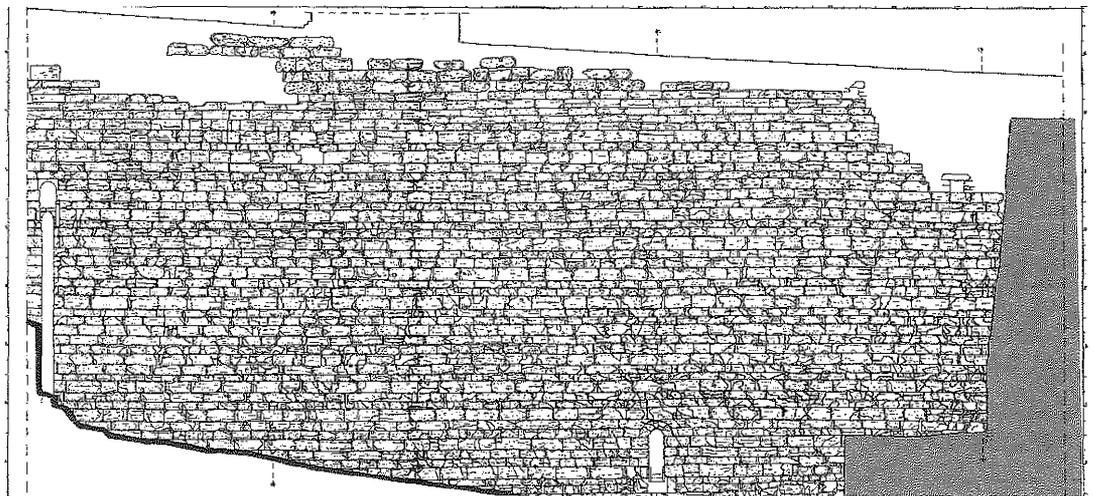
Tratto murario sopra il Fosso delle Lucrezie: prospetto generale.
